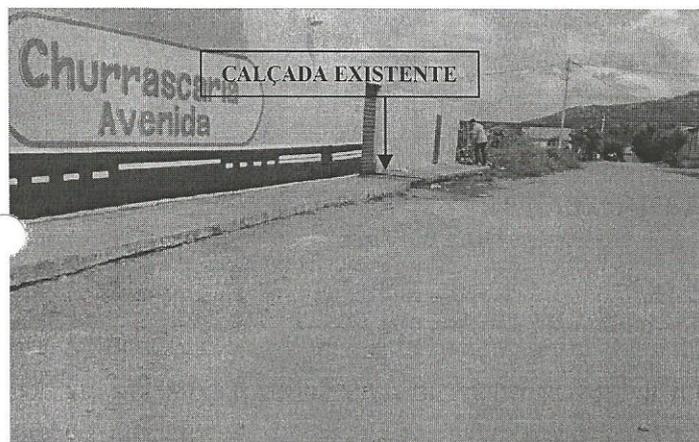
RUA S.D.O. 03 (VISÃO GERAL) DET. CALÇADA EXISTENTE 01.
